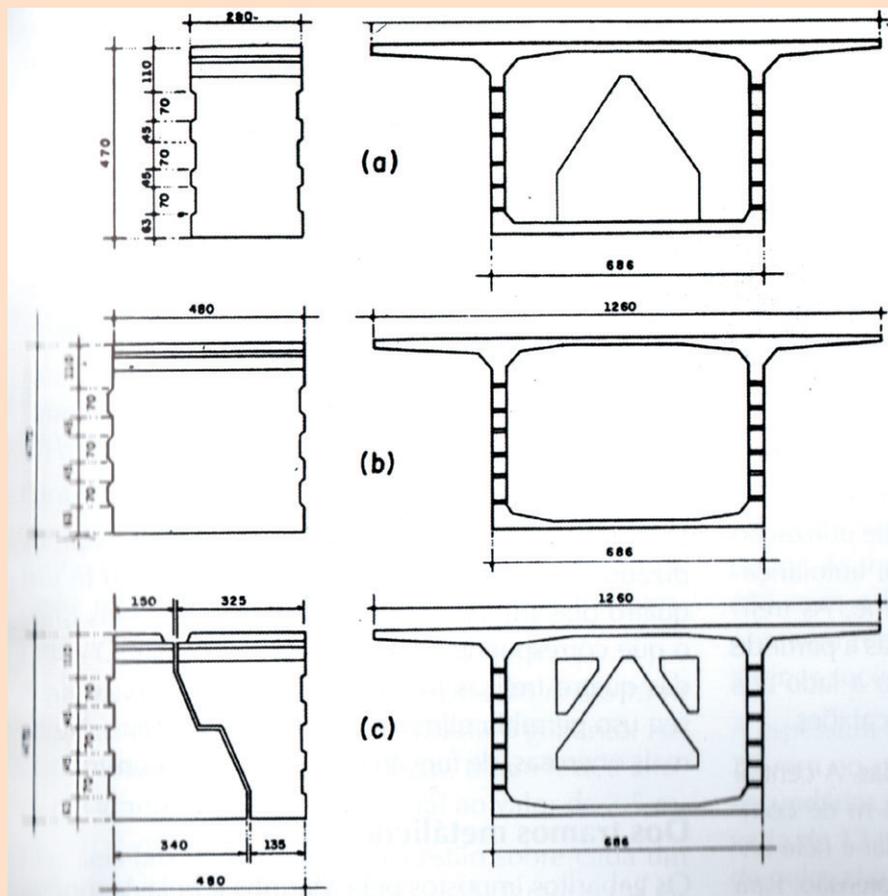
OS TRÊS TIPO DE ADUELA PRÉ-MOLDADAS: A) DE APOIO, B) ADUELA CORRENTE, C) ADUELAS DE JUNTAS [6]
